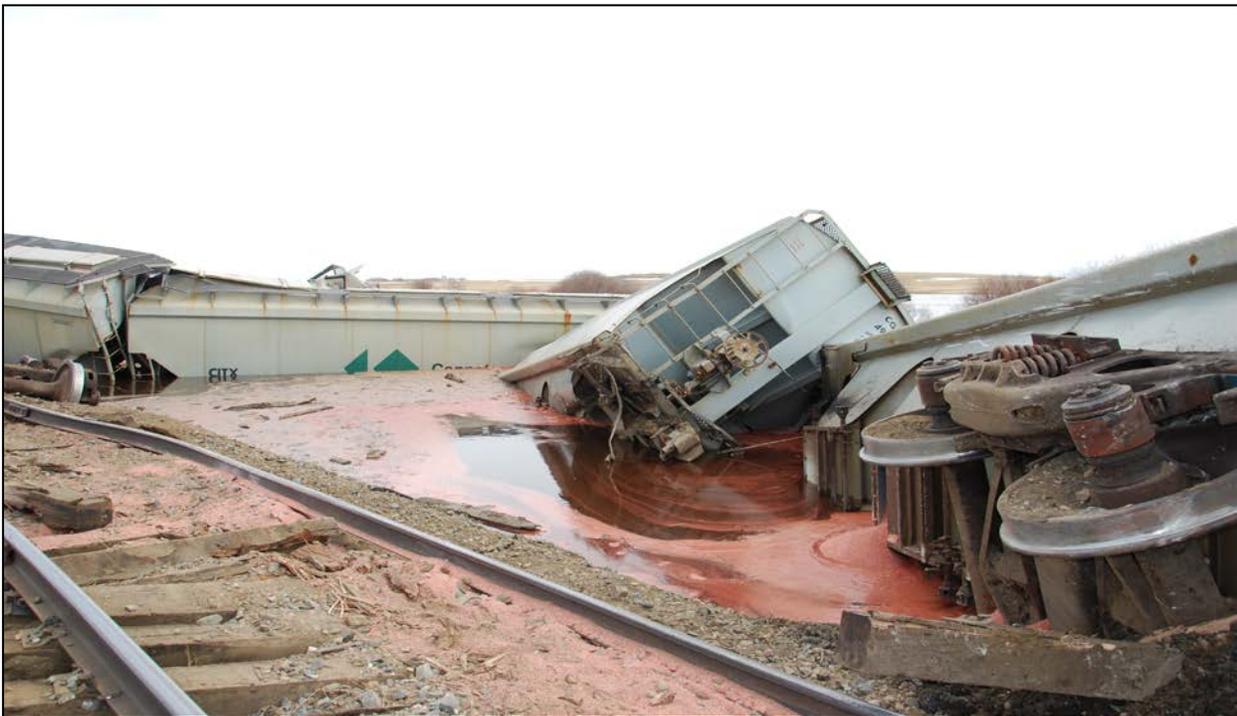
Vue vers le sud-est du site de déraillement - hautes eaux stagnantes sur le côté sud de la voie
